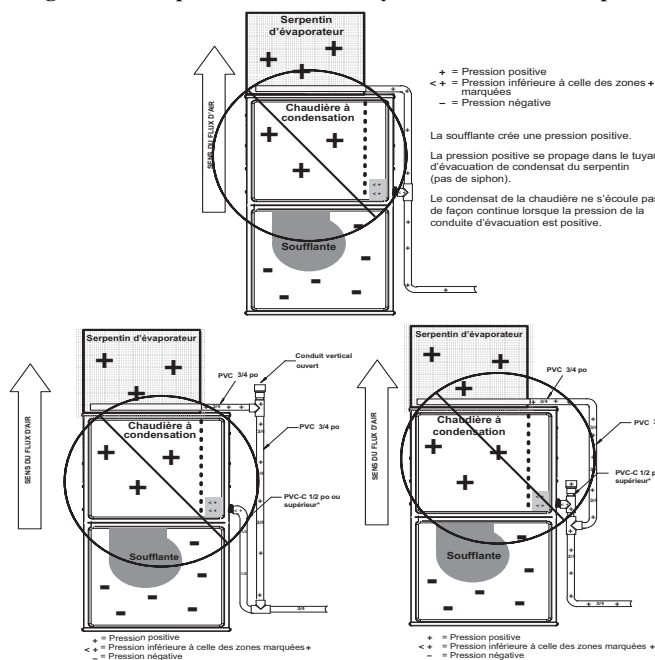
Exemple de fixation du tuyau d'évacuation sur place (non autorisée)
